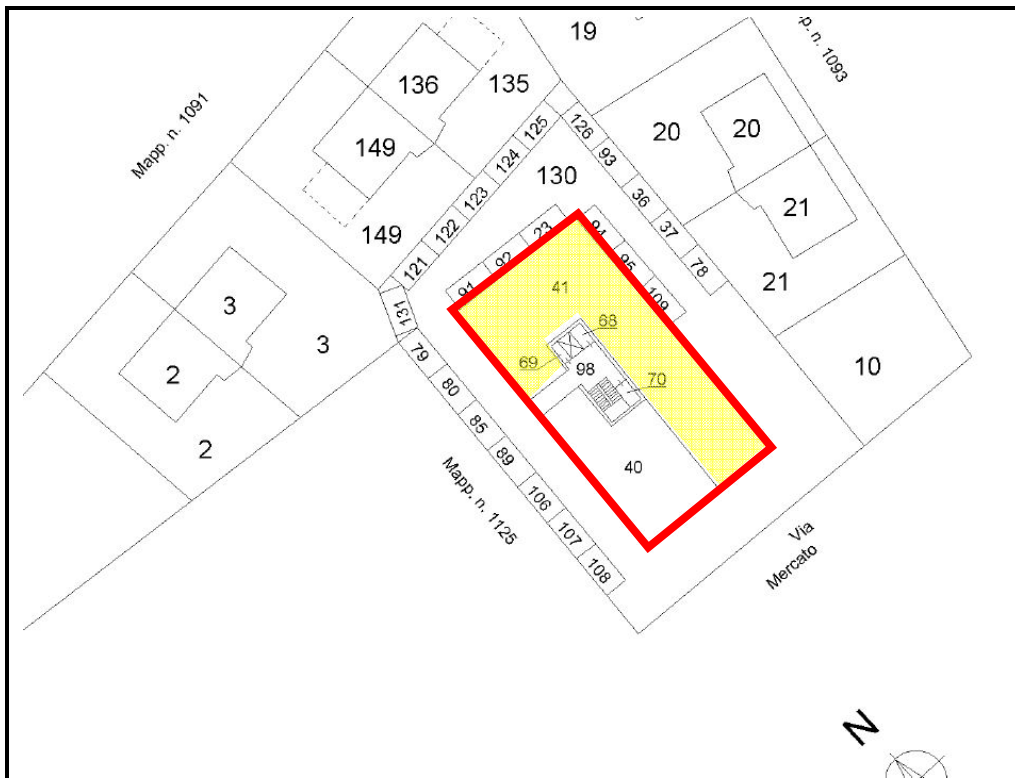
Elaborato planimetrico catastale del piano terra del fabbricato identificato con la part. 1205 (individuato da contorno di colore rosso) con indicazione del sub 41 (individuato da campitura di colore giallo).
